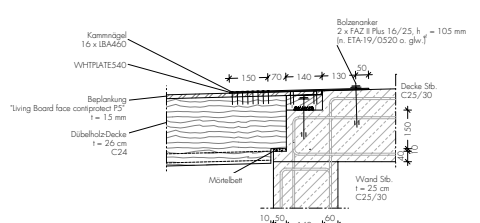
Zugstoß Dachdeckenscheibe quer zur Spannrichtung
